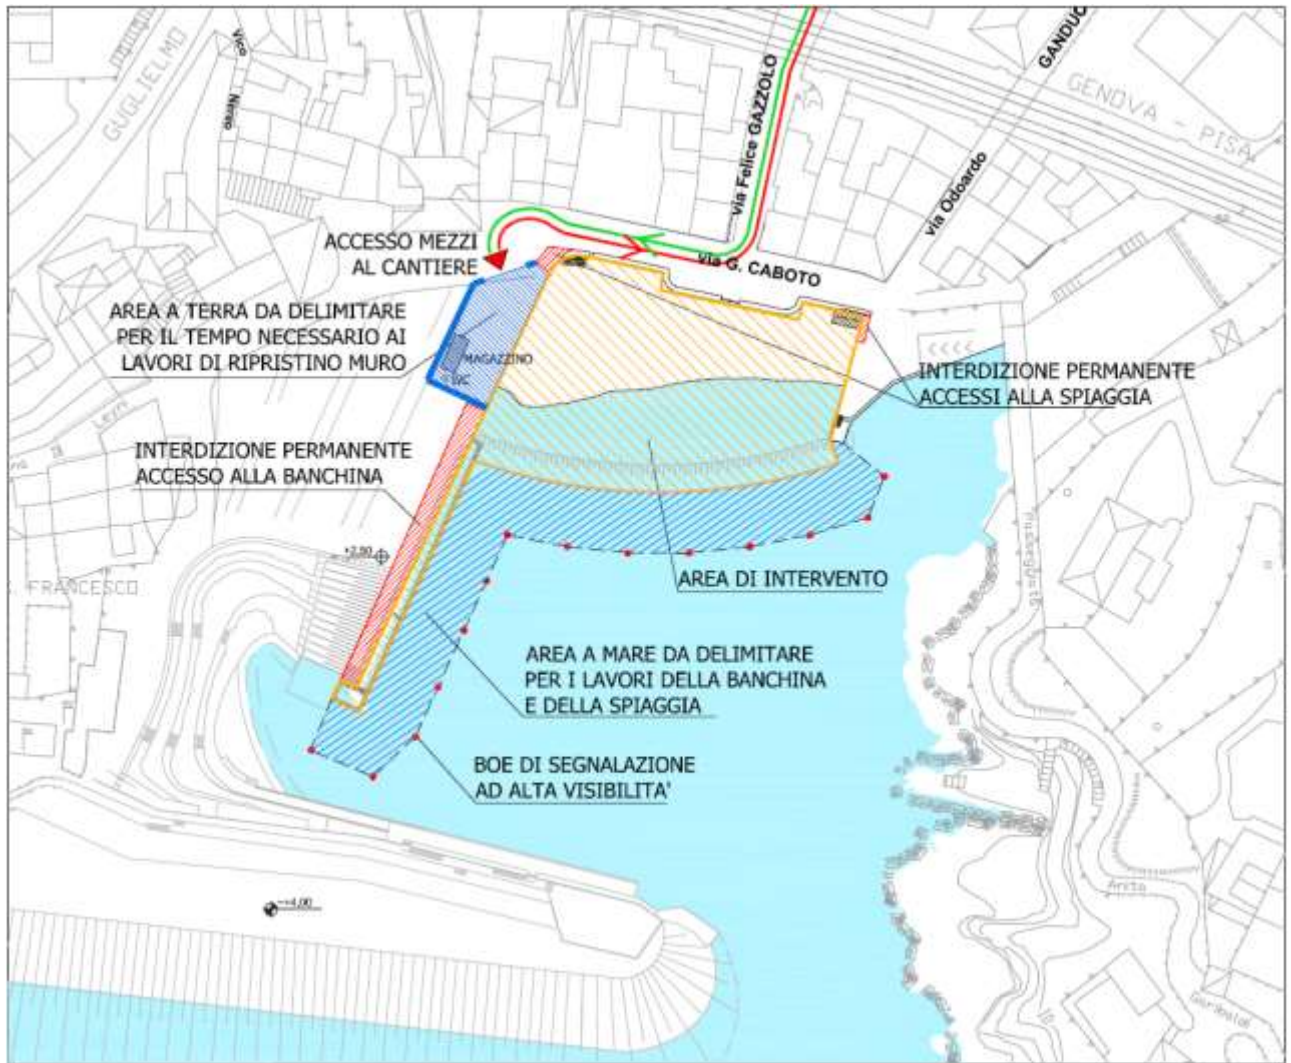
Planimetria aree di cantiere a terra e a mare da delimitare
